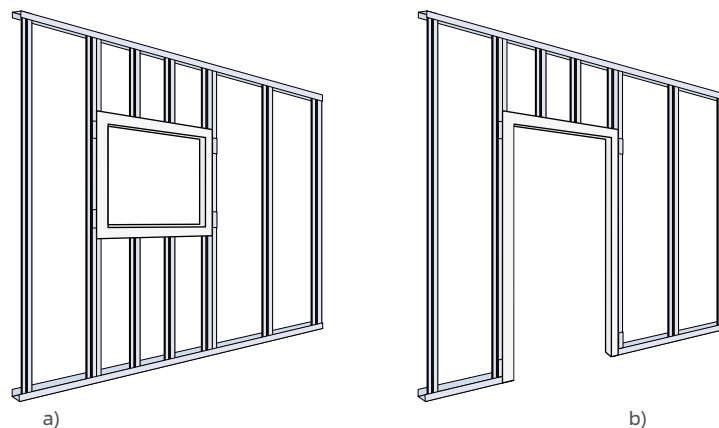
Estrutura metálica em: a) janelas; b) portas.
